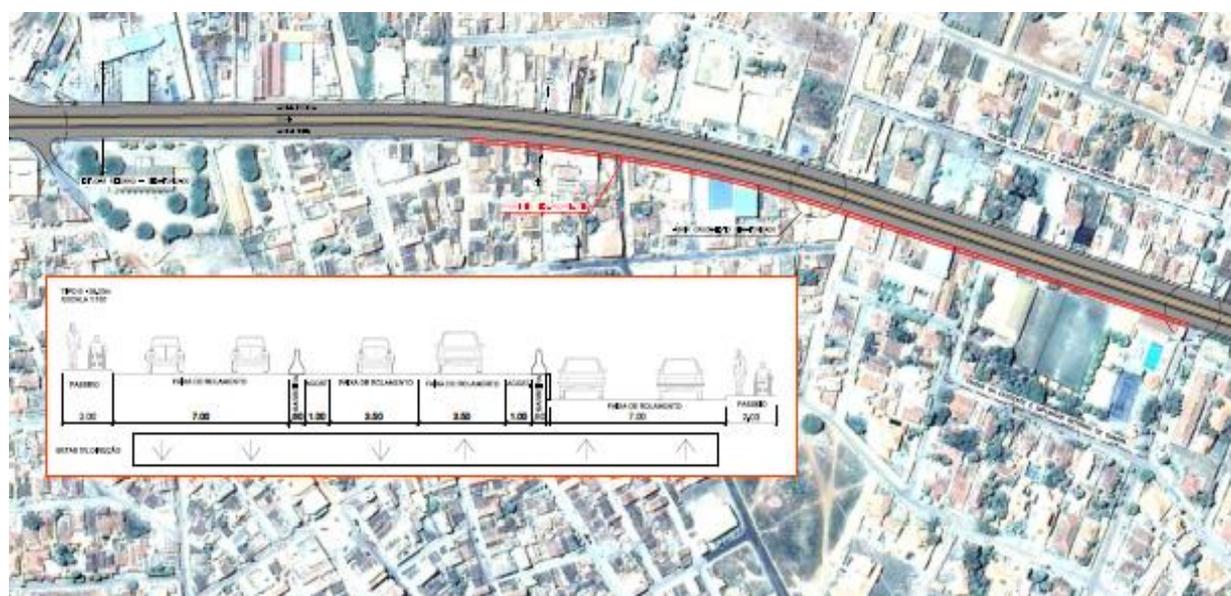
Trecho da intervenção proposta para Irecê.
